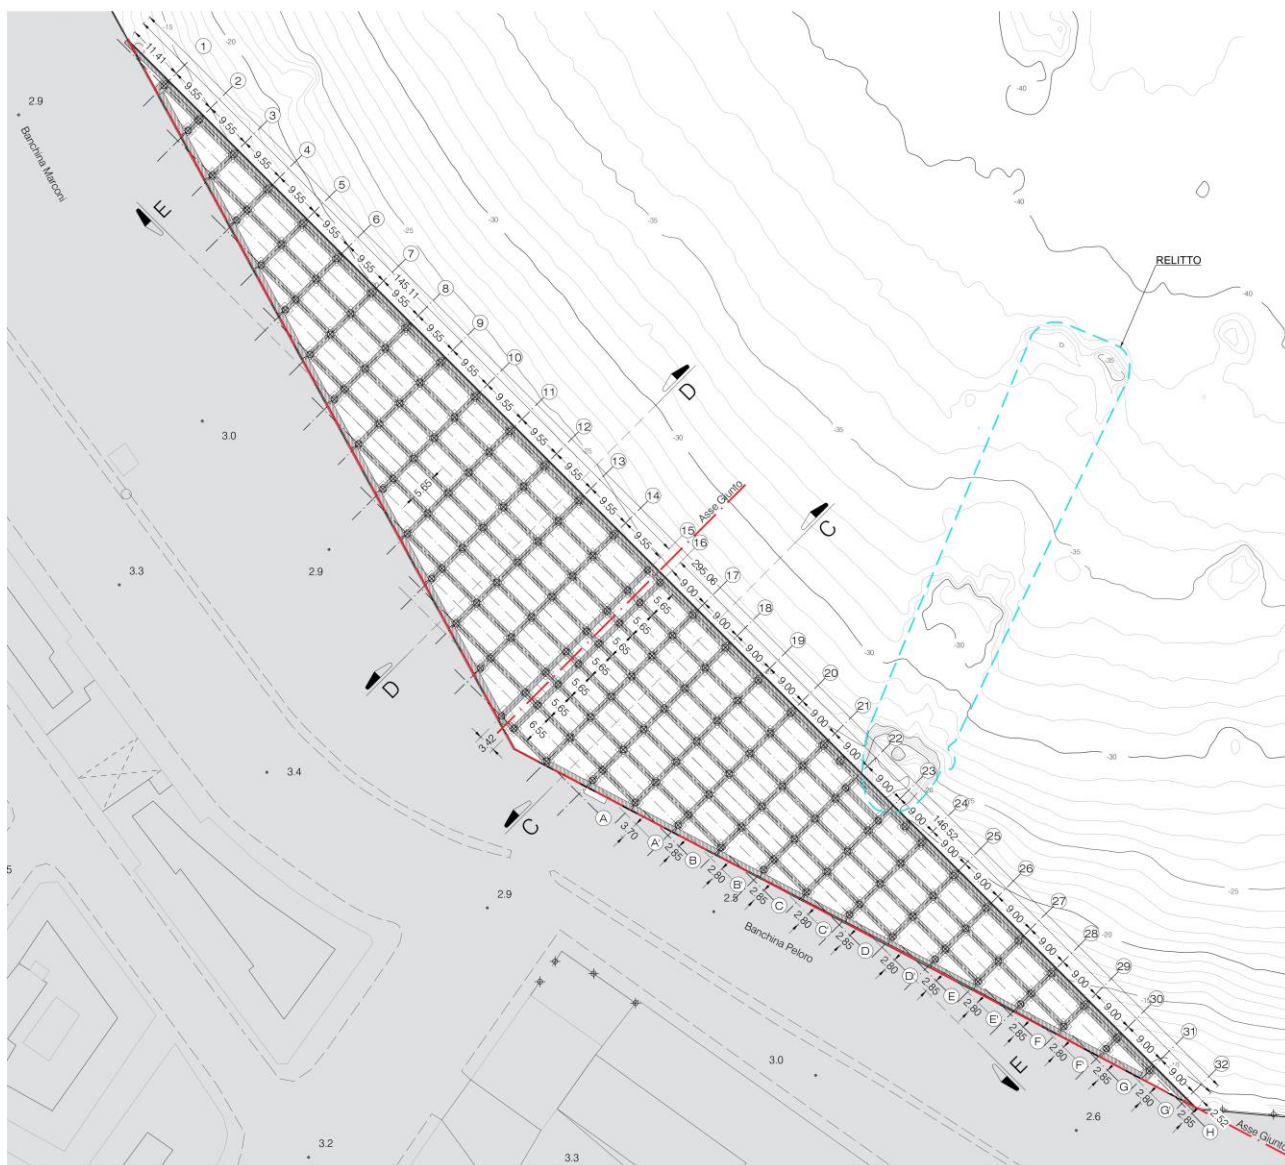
Pianta di Progetto a quota +1.00 m con struttura portante dell’impalcato
